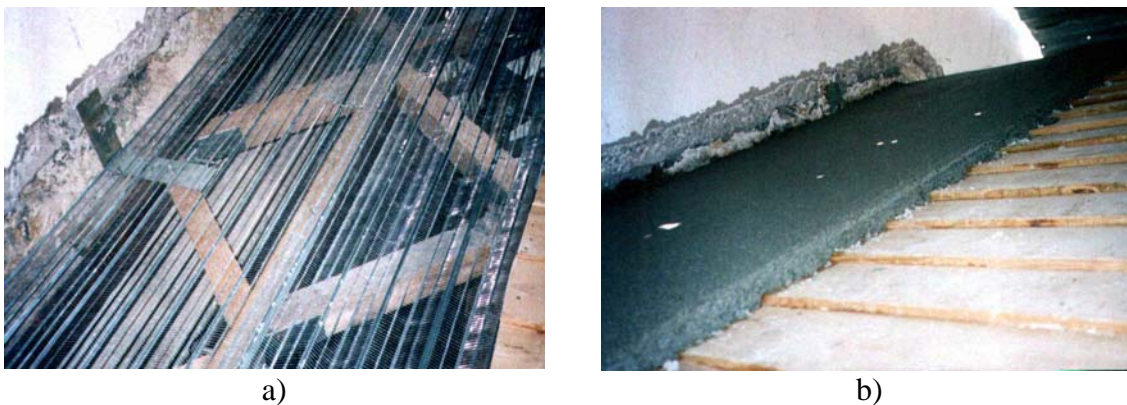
[4e]: a) Rede metálica de reforço; b) Lajeta de betão
